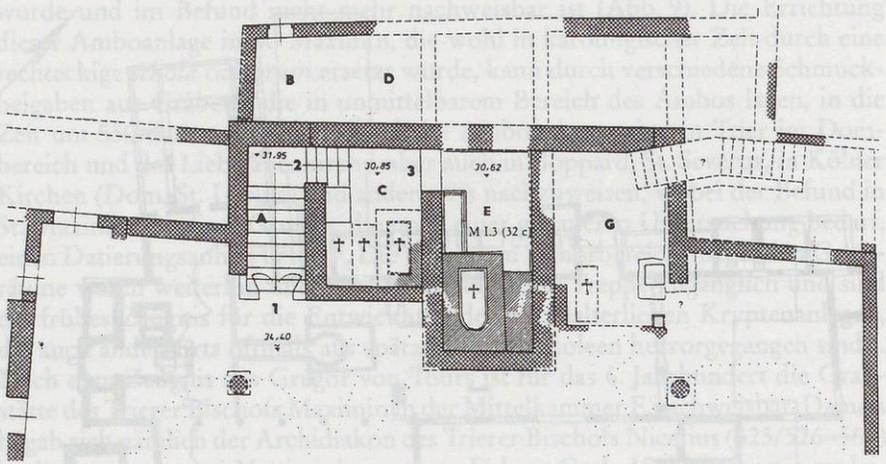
Trier, St. Maximin, Grundriss der „Krypten“
